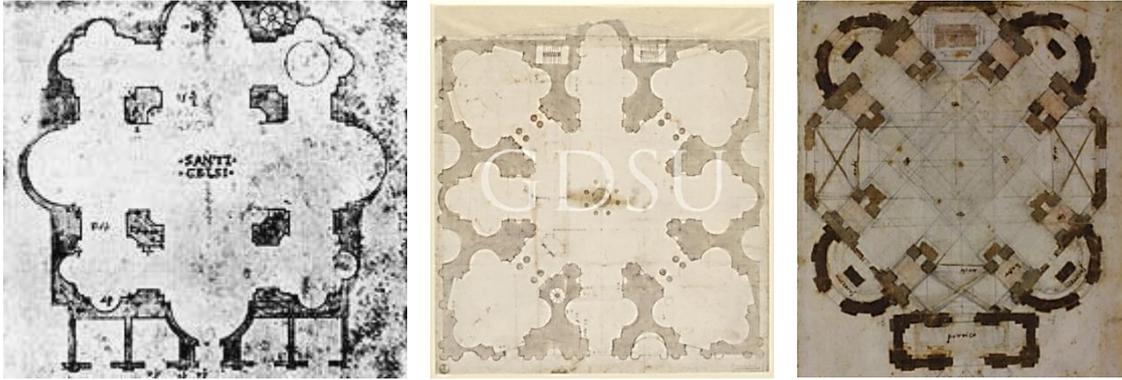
Donato Bramante. Planta para la iglesia de los Santos Celso y Giuliano, Roma. 1509. Imagen procedente del Centro Vasco de Arquitectura.
